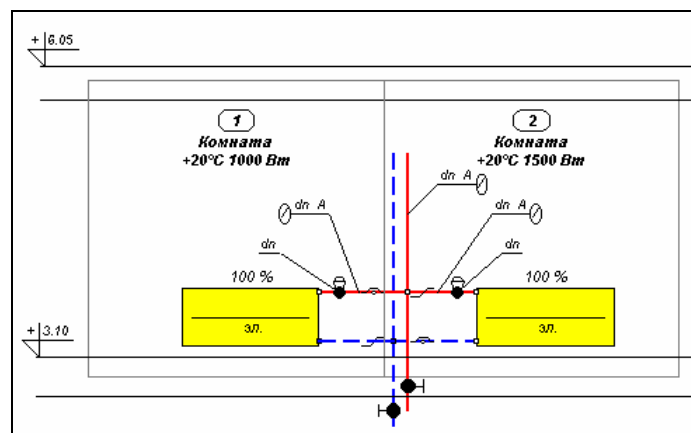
Фрагмент схемы с нарисованными этикетками трубопроводов и арматуры
